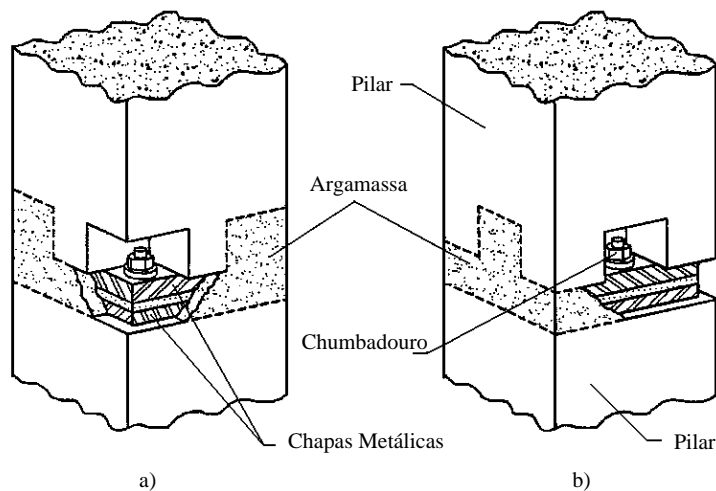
Ligação pilar - pilar com chumbadouros: a) aparafusados nos cantos do pilar, b) aparafusados no meio das faces do pilar (solução articulada), adaptado de [30]
